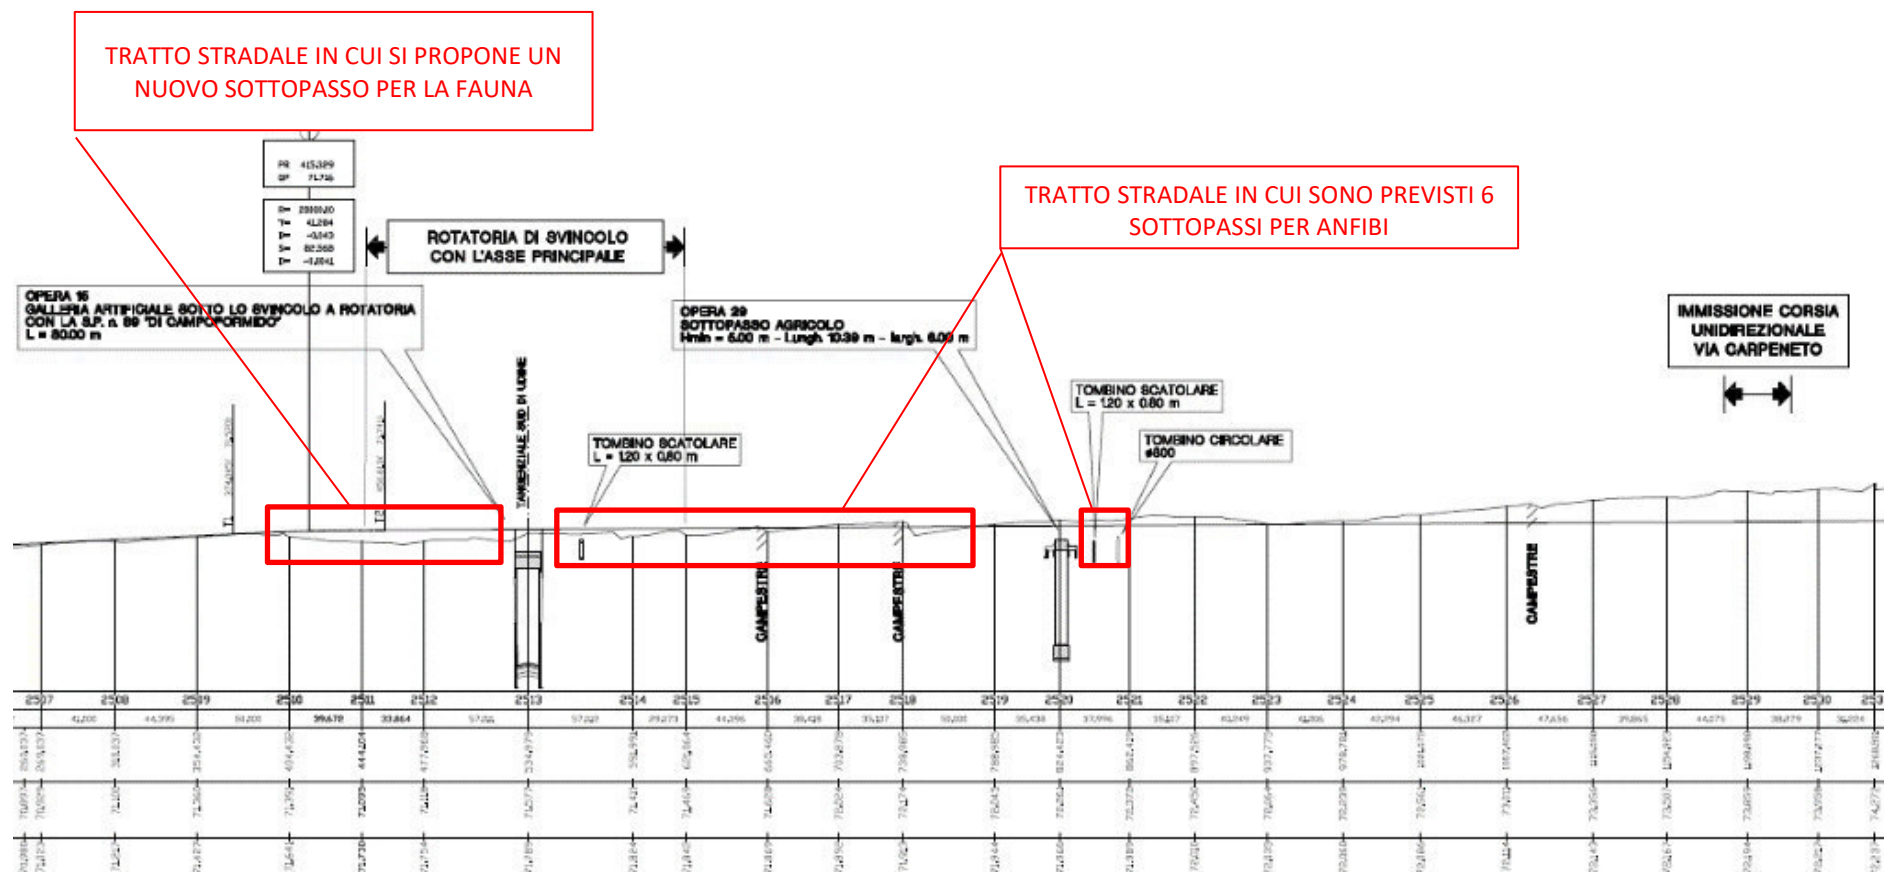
Estratto profilo longitudinale asse 25 elaborato 1207E0605200
